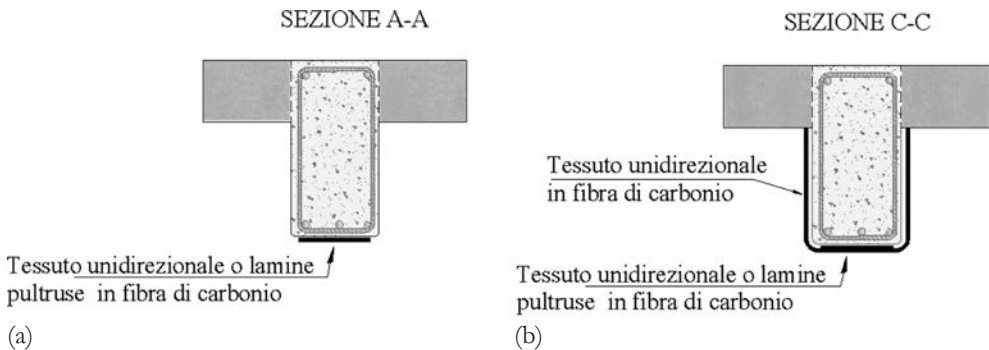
Viste in sezione: a) sezione A-A di cui alle Figure 3.119 e 3.137; b) sezione C-C di cui alla Figura 3.127.
